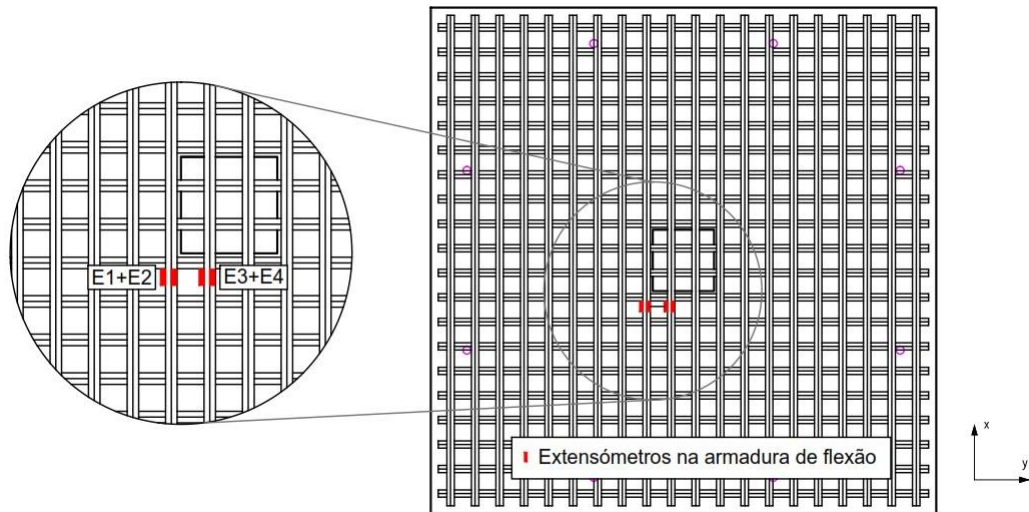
Localização e numeração dos extensômetros na armadura de flexão das lajes PBC2 a PBC5.
